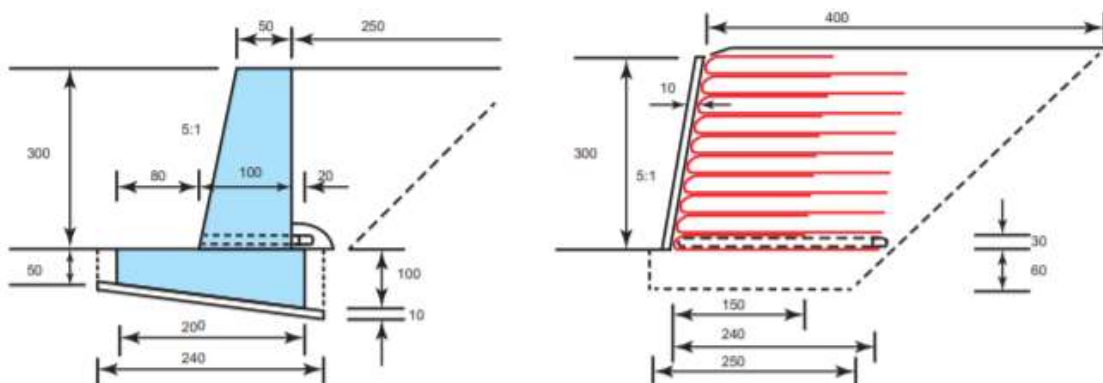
Schematische Darstellung der Stützbauwerke: Betonstützmauer (Fallstudie 4A, links) im Vergleich zur geokunststoffbewehrten Stützkonstruktion (Fallstudie 4B, rechts).
